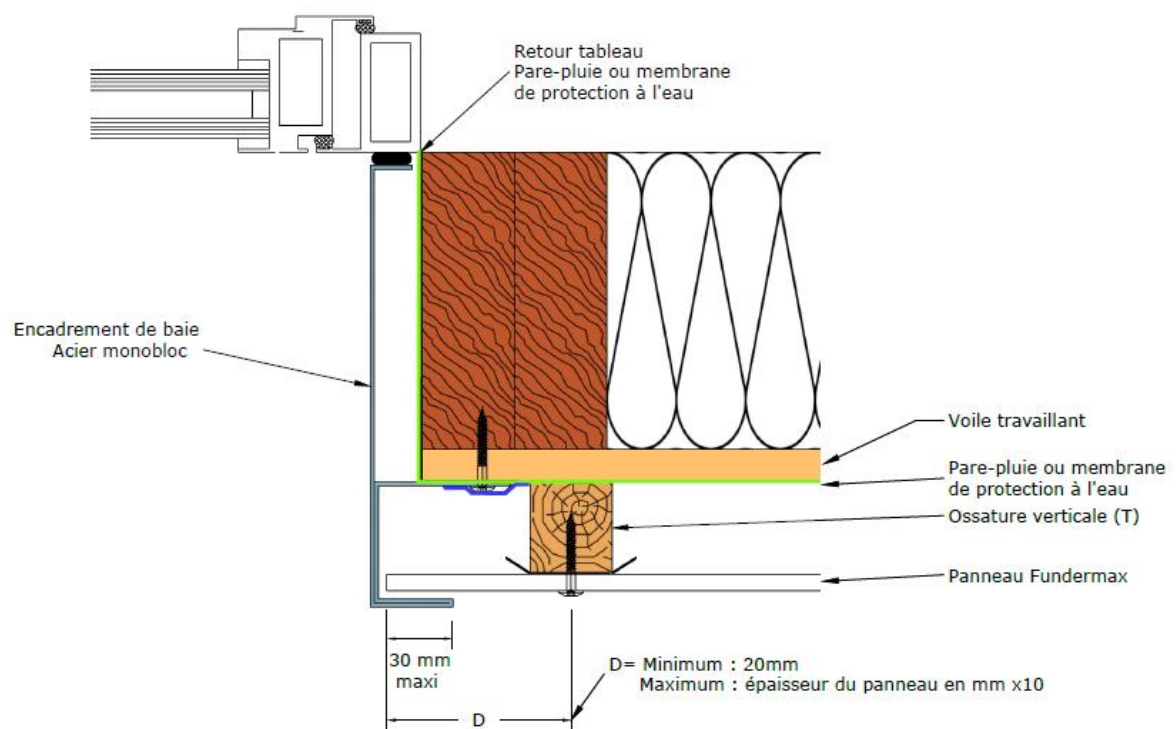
Encadrement de baie Ee2, acier 15/10<sup>e</sup> monobloc soudé 4 cotés, bardage sur FOB, coupe horizontale
